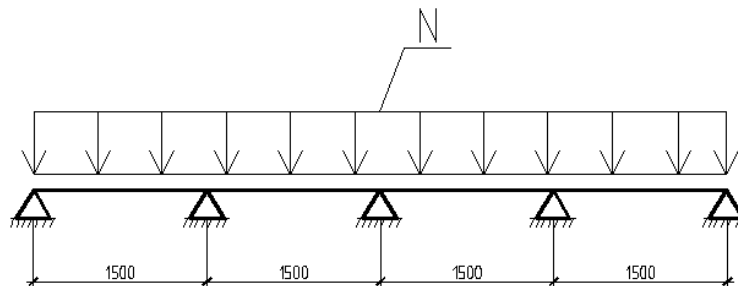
Схема распределенной нагрузки на разрезную балку.
